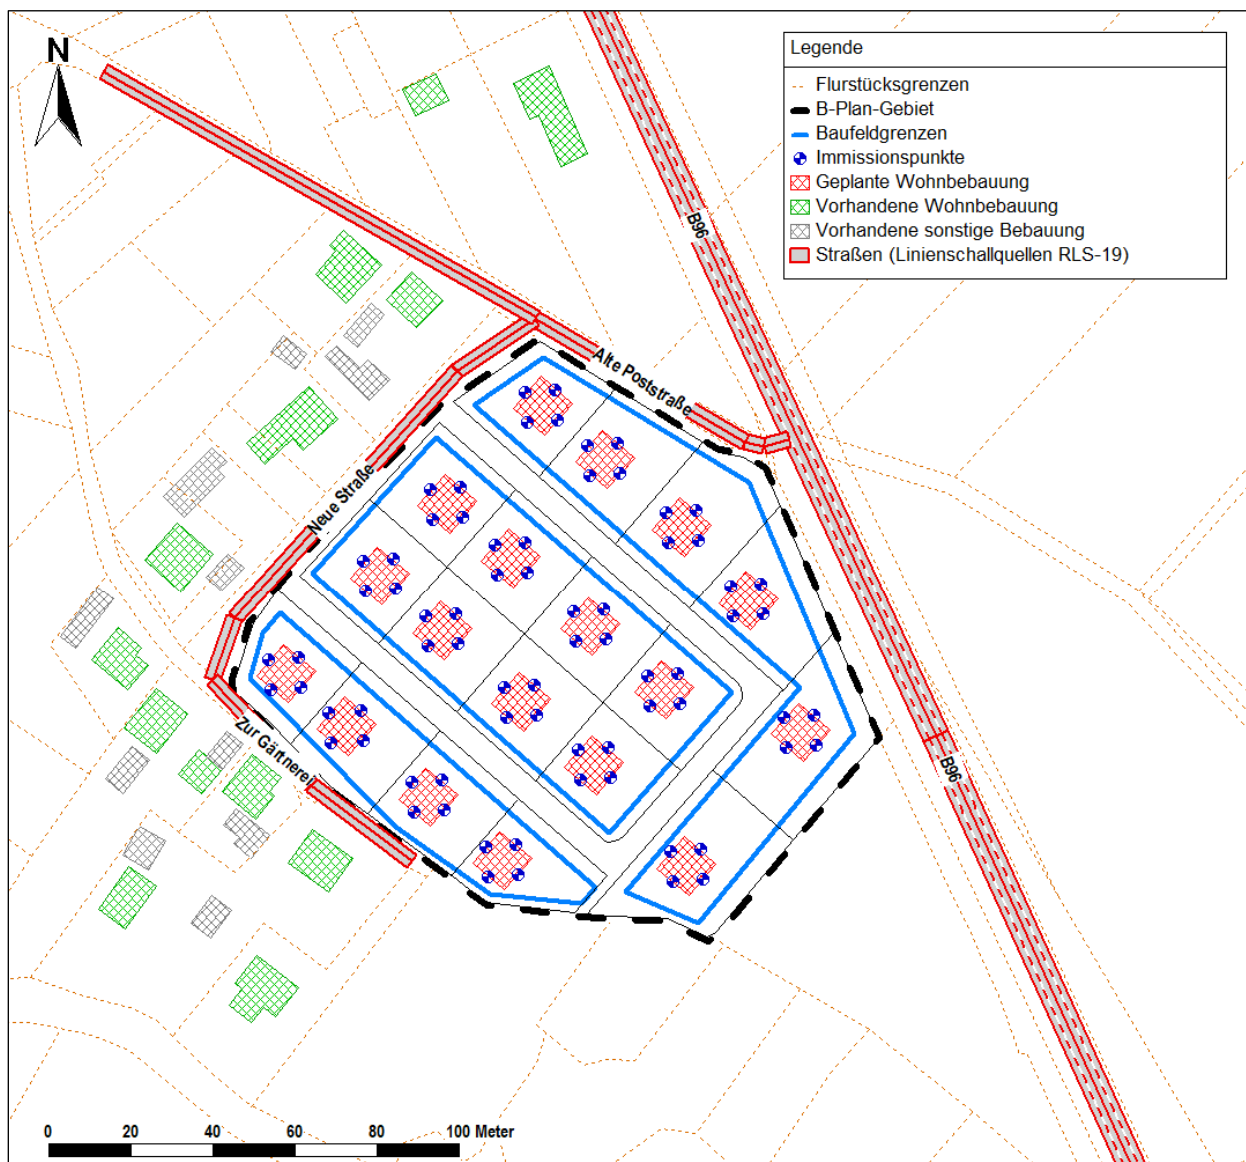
Übersichtslageplan des Rechenmodells (Ausschnitt)
